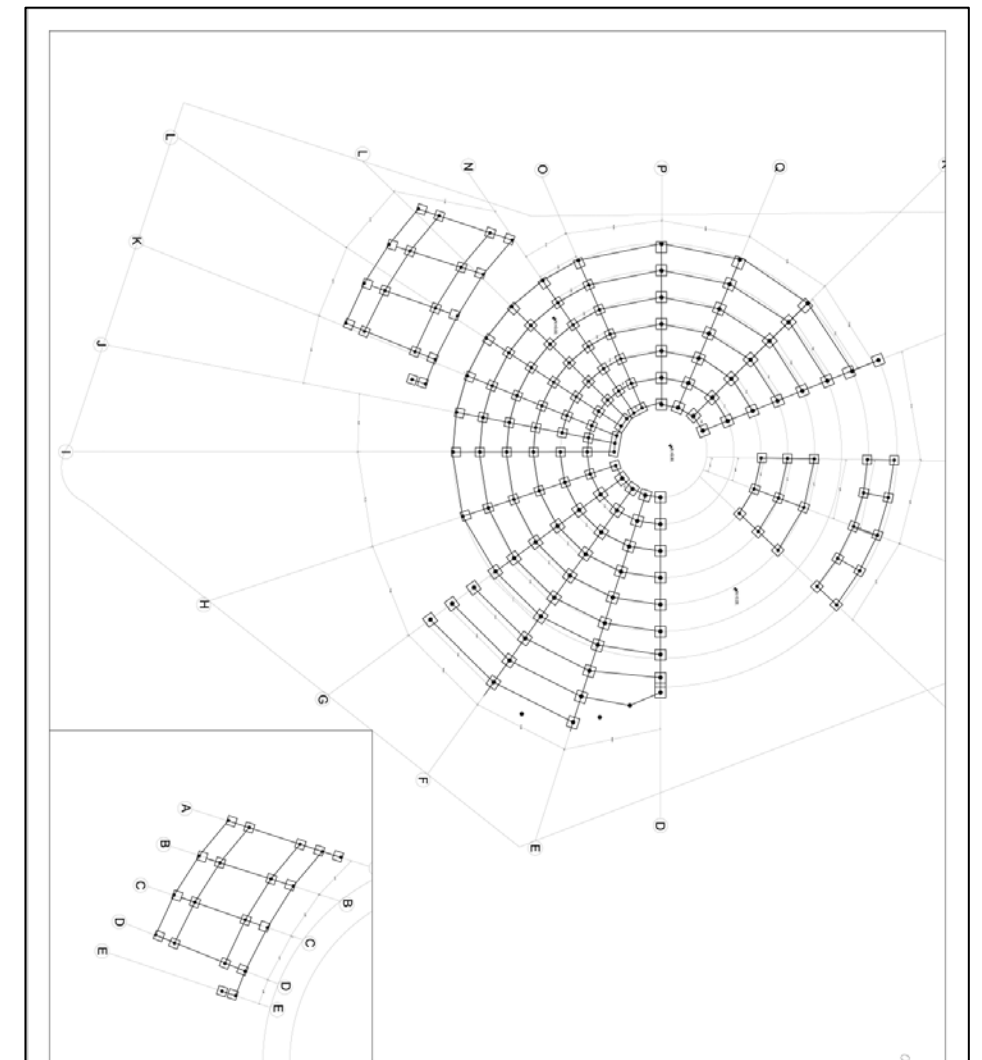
Esquema columnas- vigas – plintos- zapatas .
